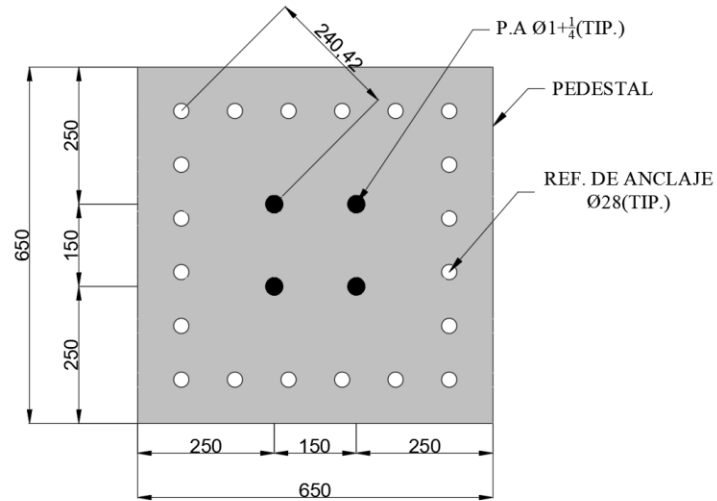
Detalle de distancia entre anclajes y refuerzo más alejado.
